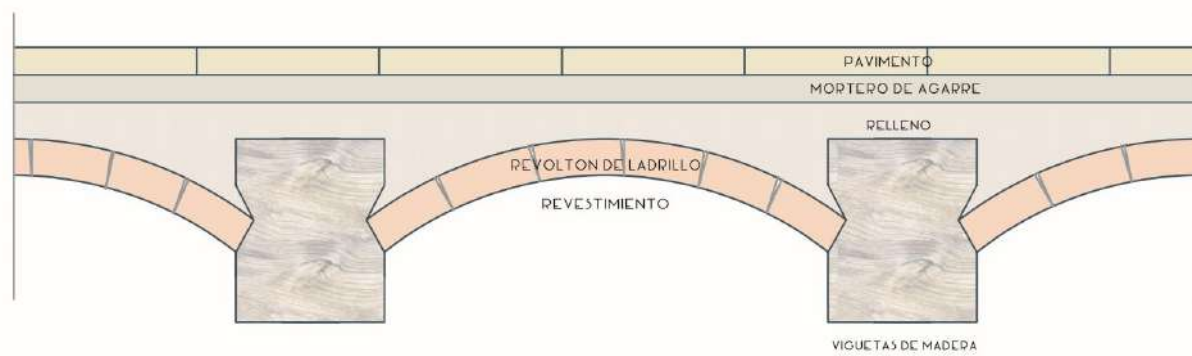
Detalle de forjado. Fuente: Elaboración Propia.
